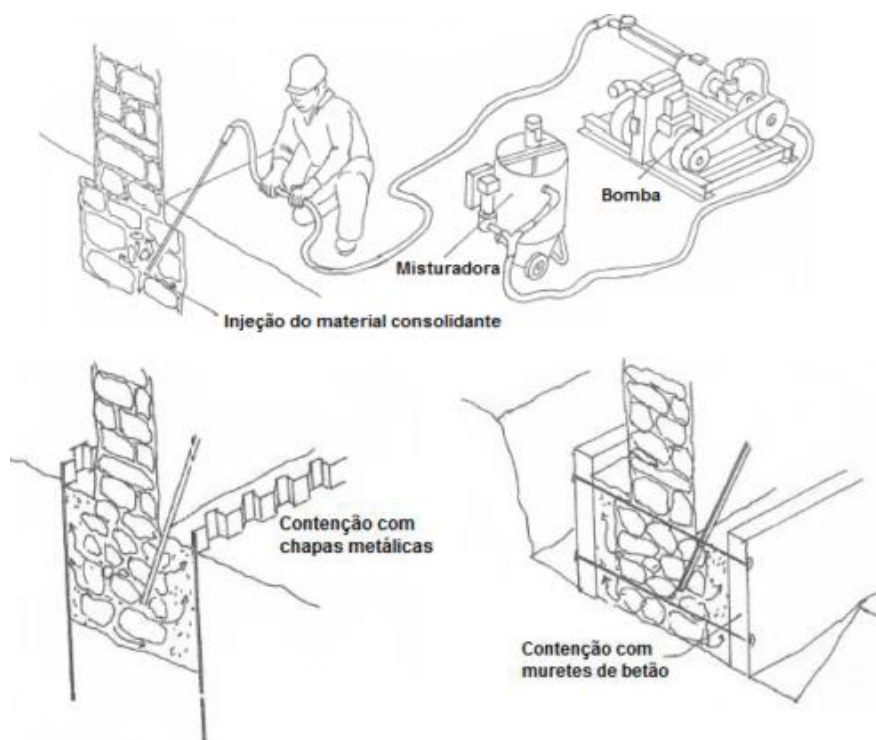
Esquema de consolidação de fundações através de injeção (Reabilita & Funda, 2014)
